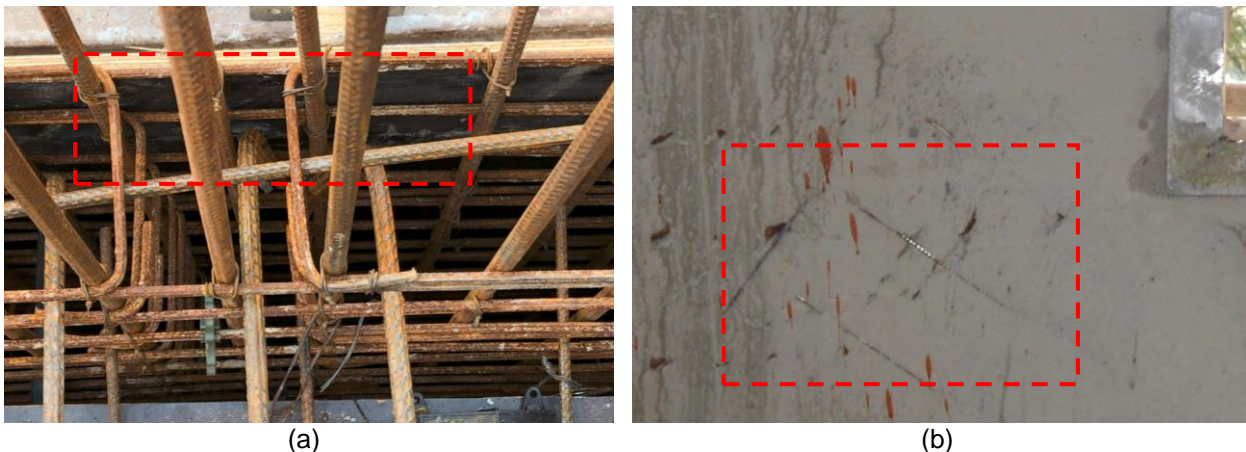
(a) Região sem espaçador e armadura em contato com a fôrma e (b) parede de concreto com armaduras sem cobrimento adequado pelo concreto (Arquivo Deseq, 2022)
